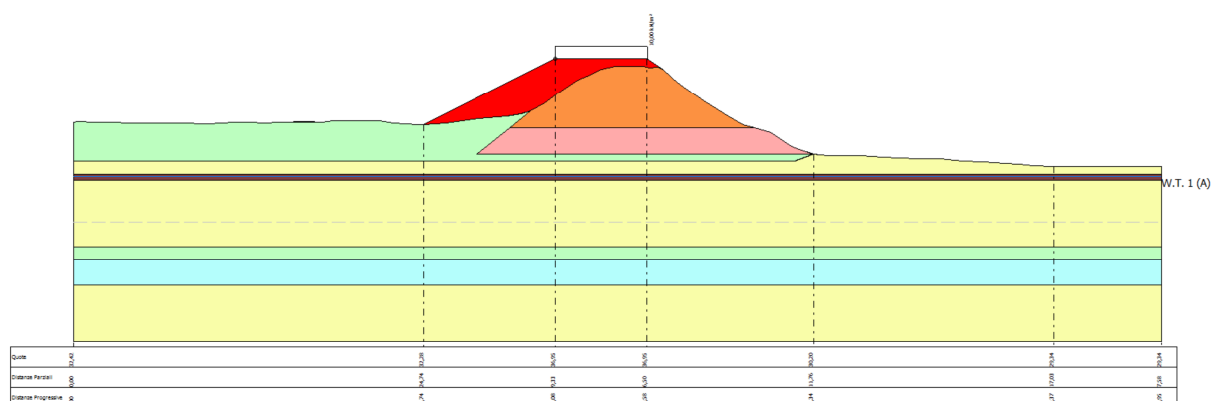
Schematizzazione della sezione ST092_DX di verifica dei cedimenti dei terreni di fondazione
